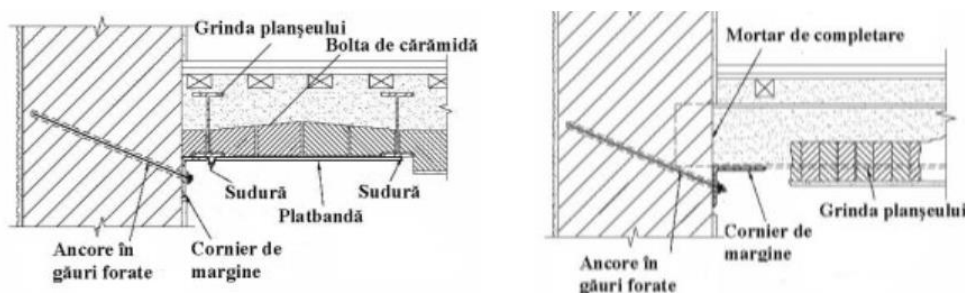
Suprabetonare planșee existente – soluție de principiu
